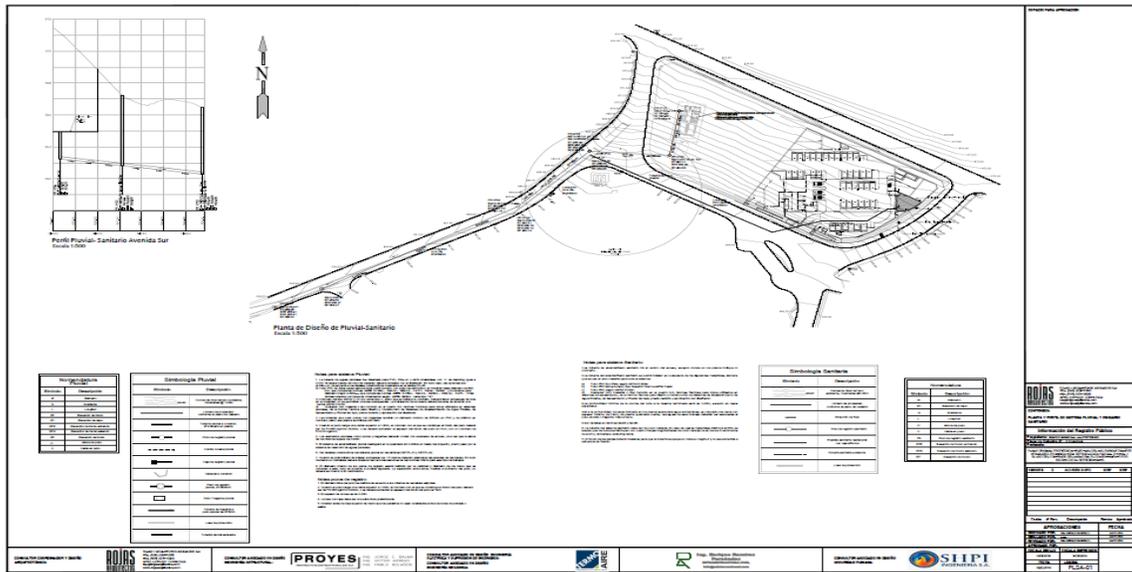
Planta de Conjunto. Sección # 1 de trayecto de tubería pluvial y sanitaria sobre sobre calle cantonal hasta descarga en Río Bermúdez, lámina # PLSA-01 de los planos presentados.
